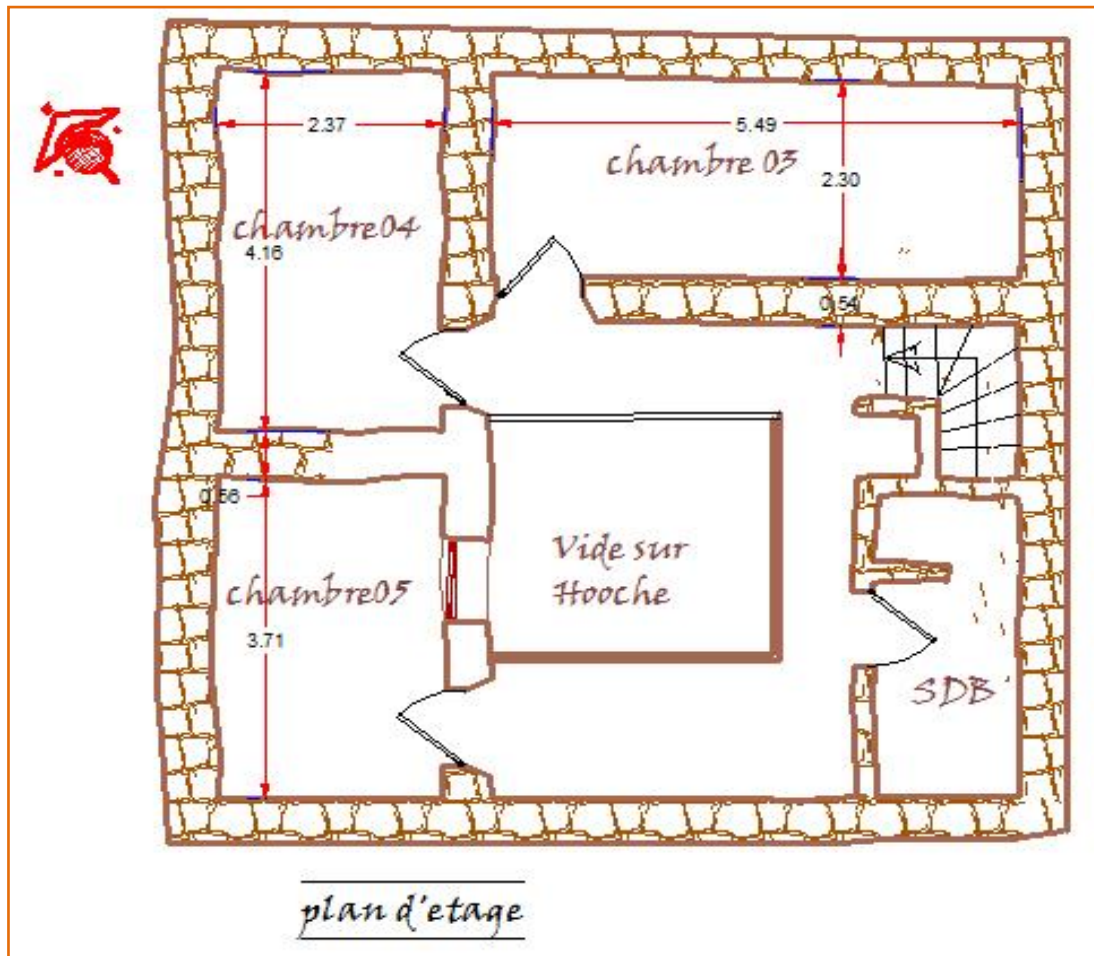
plan d'étage de la Maison du cas d'étude (Source: auteur)
